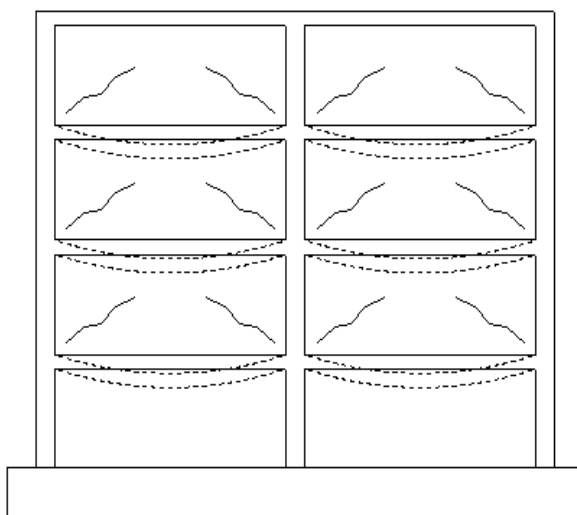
Fissuras causadas por deformação excessiva da estrutura. Fonte: (CARMONA apud AGUIAR, 2016)
